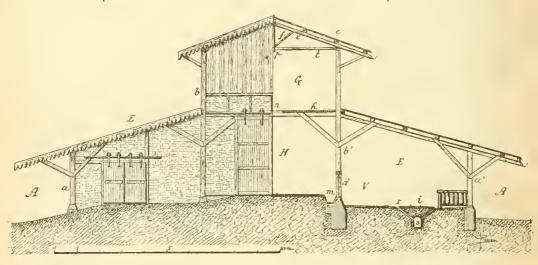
Elévation et coupe de la vacherie de Forges.
